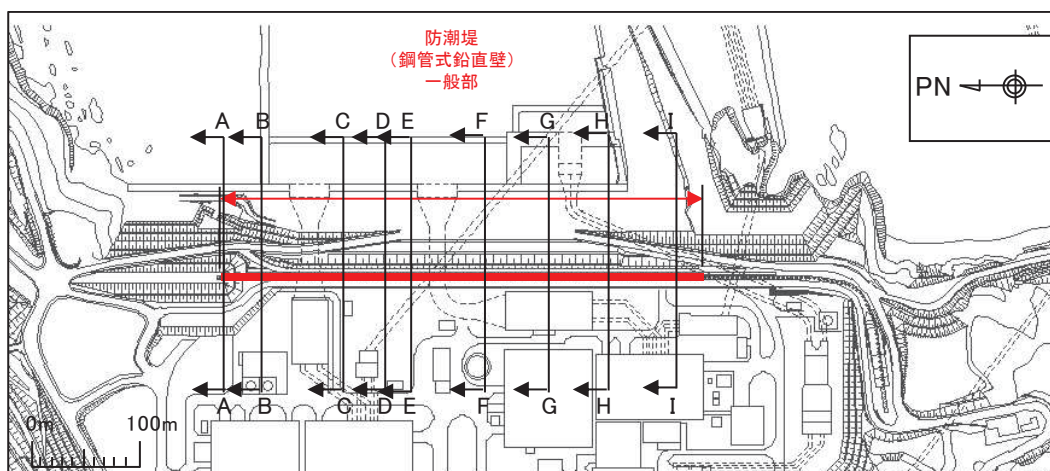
鋼管式鉛直壁（一般部）平面配置図
